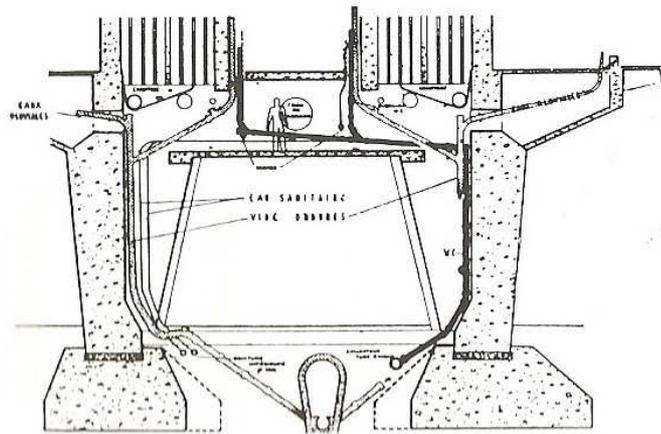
Detalhe dos pilotis e pavimento técnico
